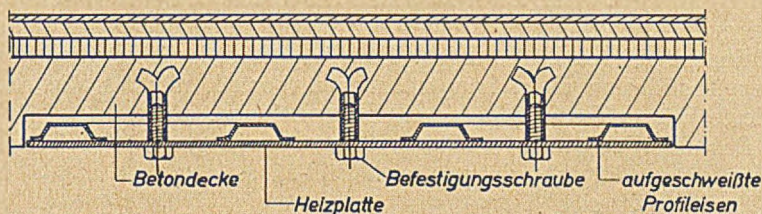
Ausführung einer Deckenheizung nach dem DRP. 519096.
